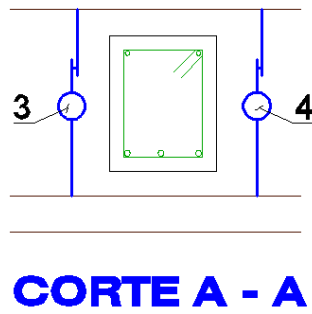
Ubicación de los deformímetros mecánicos en las vigas
